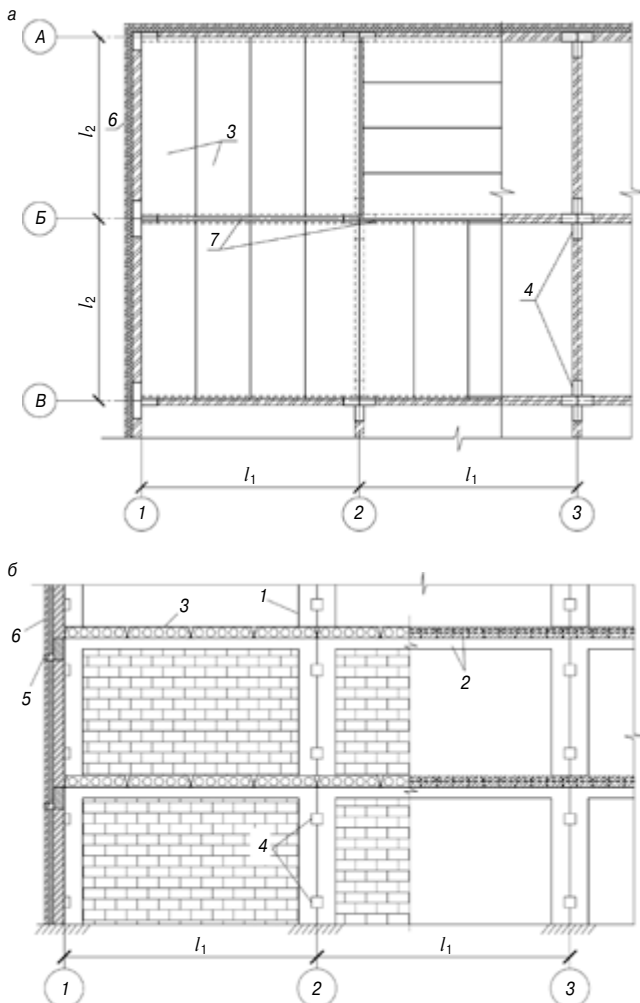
Схема горизонтальных (а) и вертикальных (б) связей в многоэтажном каркасно-панельном здании: 1 – стойка панели рамы; 2 – сборно-монолитный ригель; 3 – панель перекрытия; 4 – вертикальные связи; 5 – обвязочный ригель; 6 – наружная стена; 7 – горизонтальные связи в плоскости перекрытия
